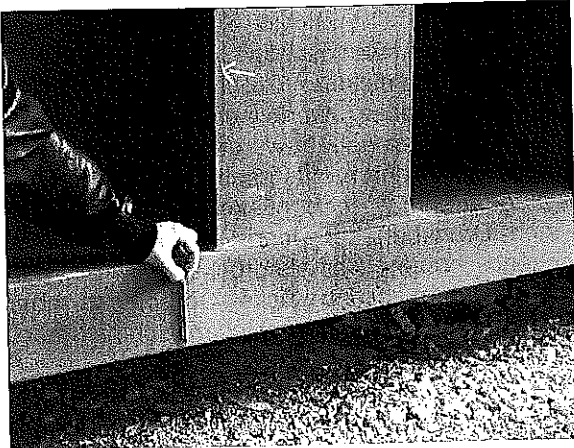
Verbundbrücke mit geschweißtem T-Träger und 150 mm Flanschdicke
